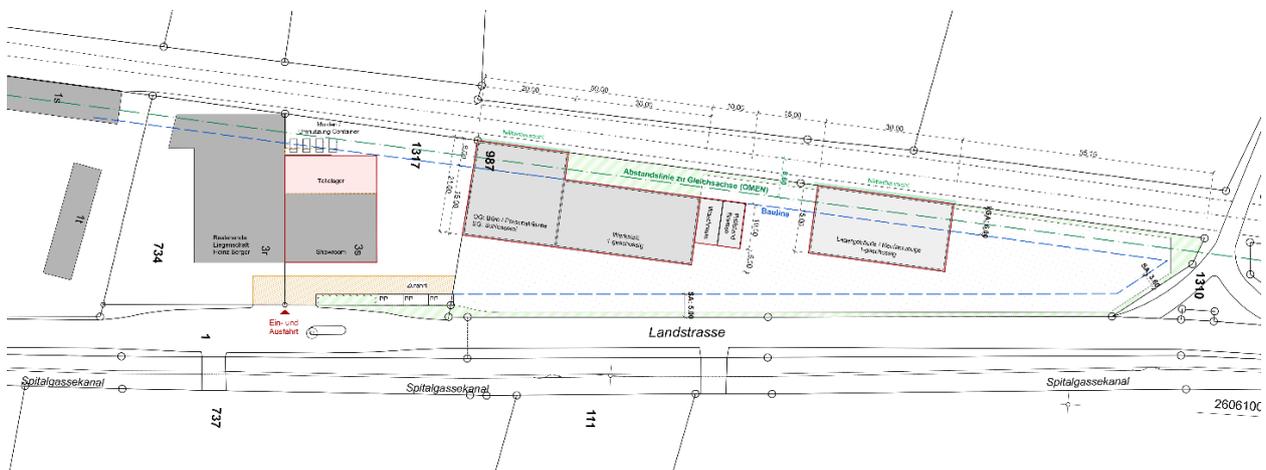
Situationsplan Parzelle 987 mit Bebauungs- und Erschliessungskonzept
